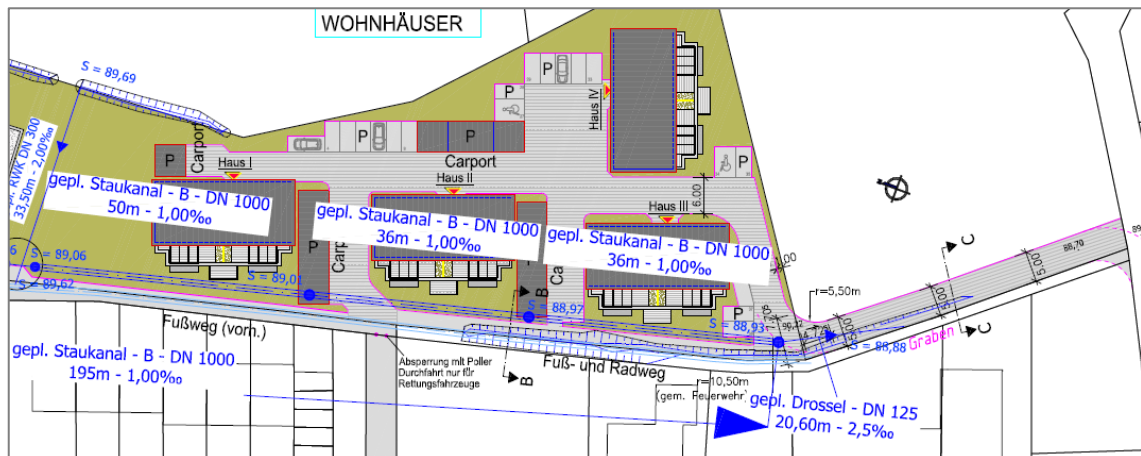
Lageplan zur wasserwirtschaftlichen Voruntersuchung zum vB-Plan Nr. 4 „Südlich der Hannoverschen Straße“ (INGENIEURBÜRO J. BERGEMANN GMBH 2014)
